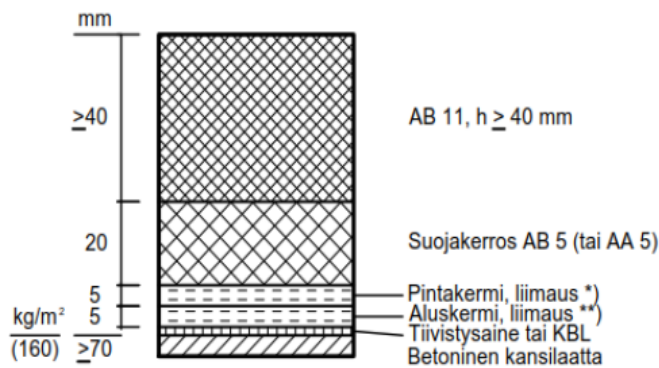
Betonikantisen sillan pintarakenteet suojabetonia ja kermieristettä käytettäessä (Väylävirasto 2019, 53).
